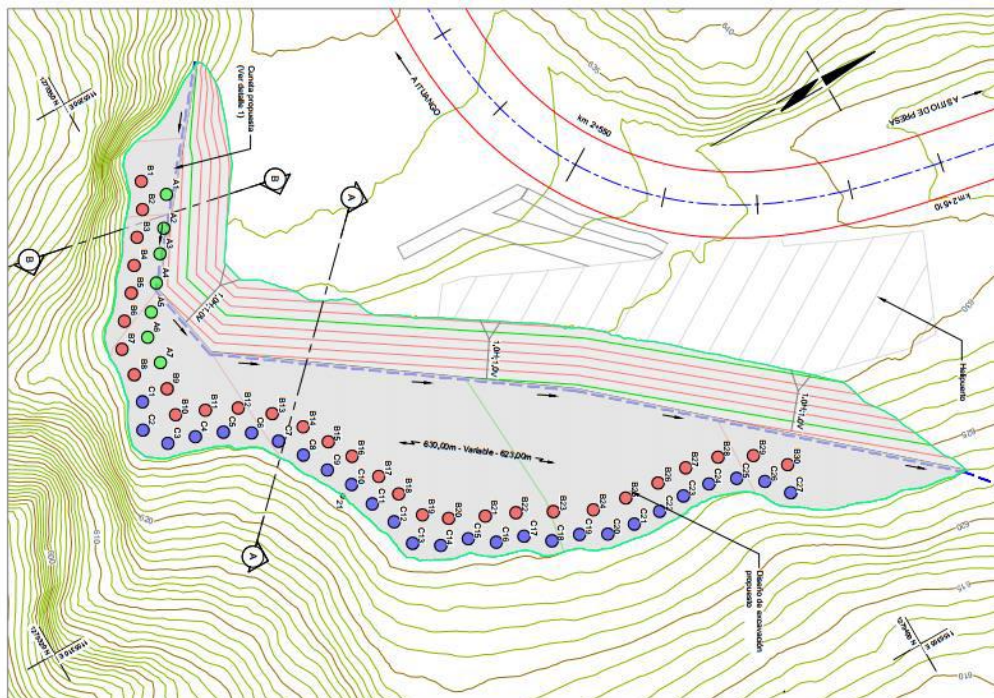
Geometría plazoleta de excavación y localización en planta de inyecciones de consolidación.
